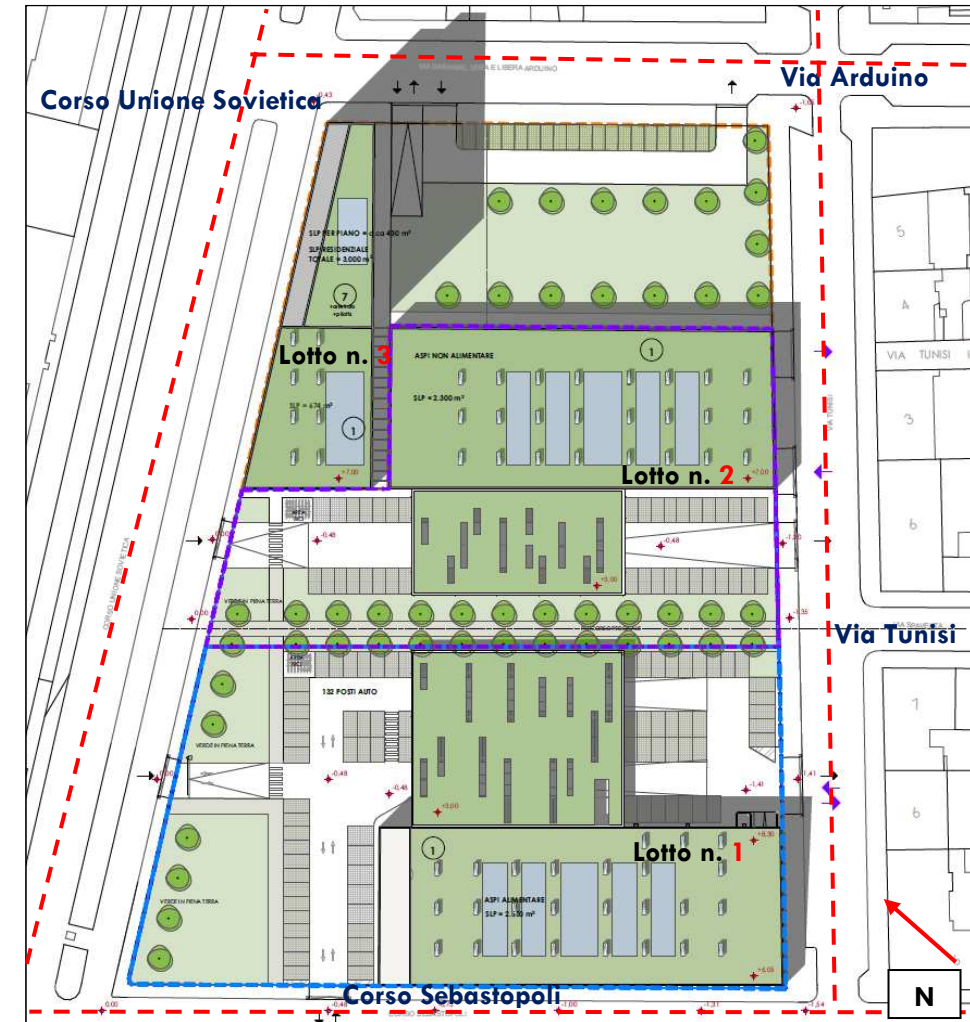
Estratto progetto architettonico: planimetria P.E.C.
